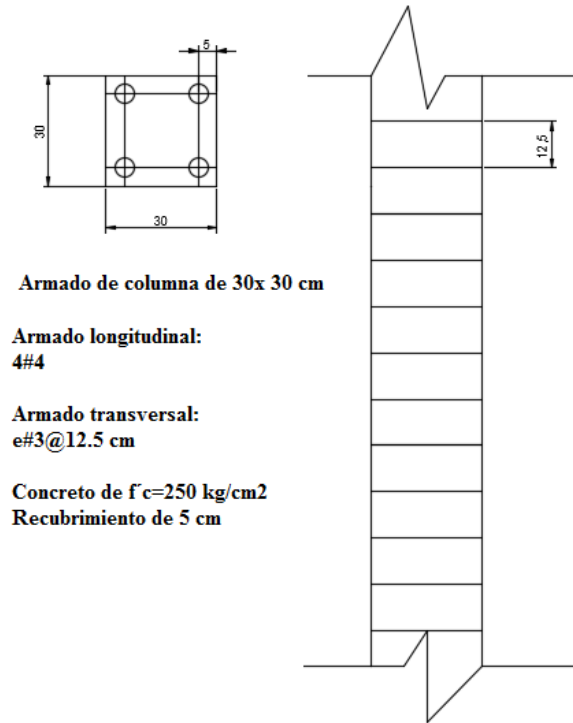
Armado de columnas correspondientes a la estructura de un nivel.
